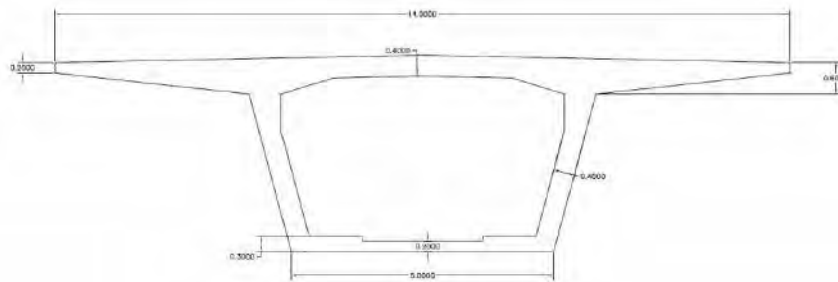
Sección Transversal del Tablero. Alternativa Cajón de Hormigón
